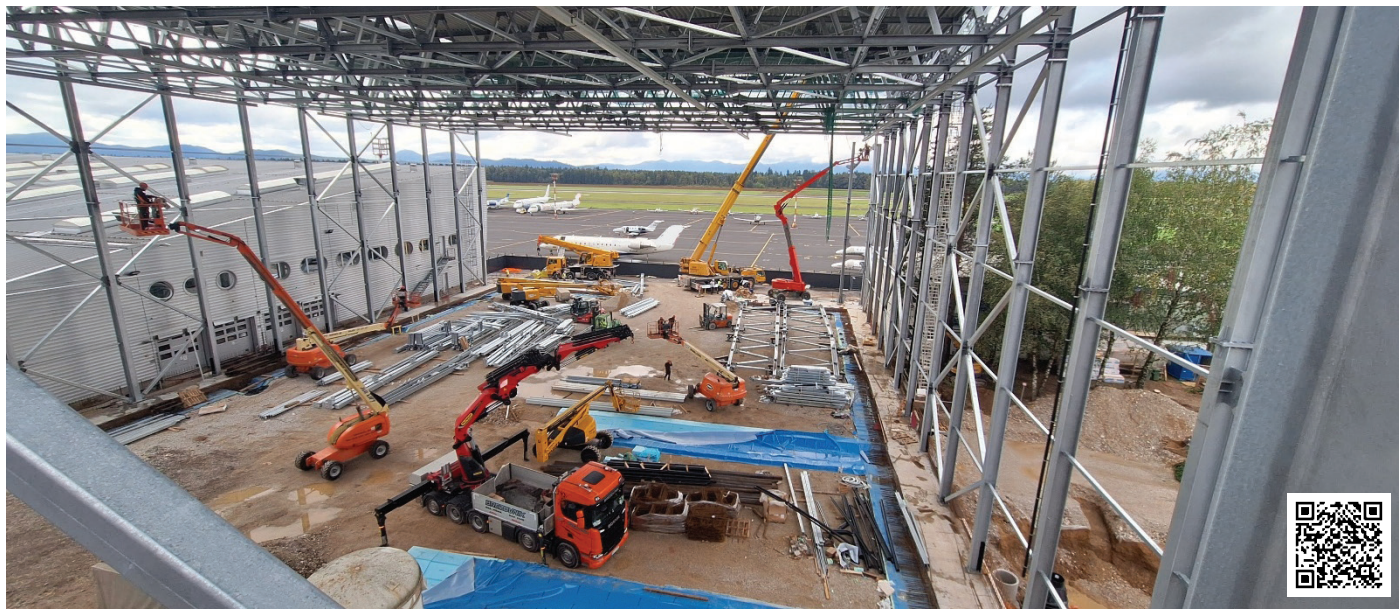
Konstrukcija hangarja (foto: Jernej Nučič).
